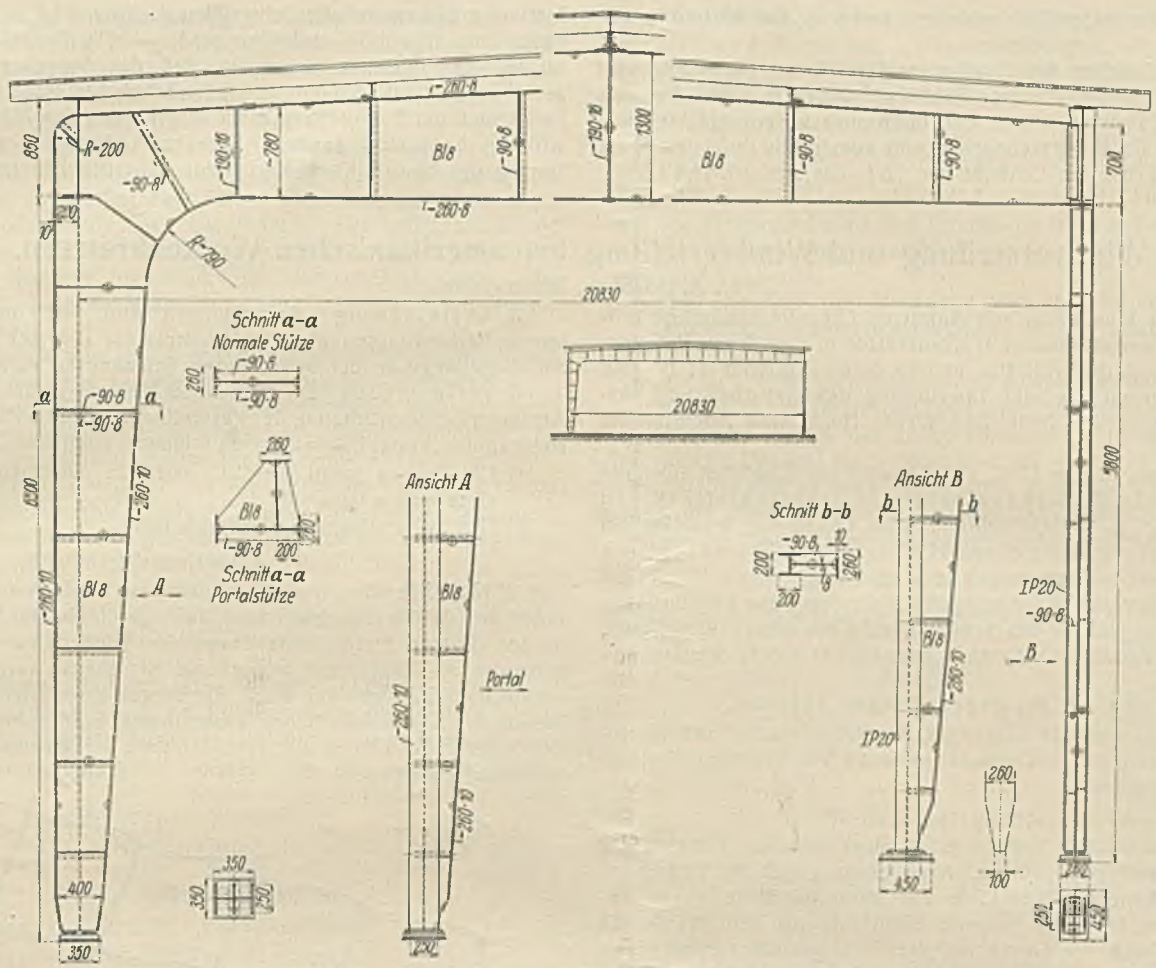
Hauptbinder und Stützen mit Portalanschluß.
